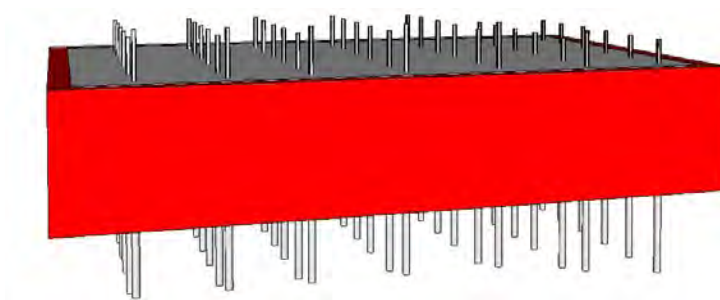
Visualización 3D del estado inicial zona E sin excavar.
